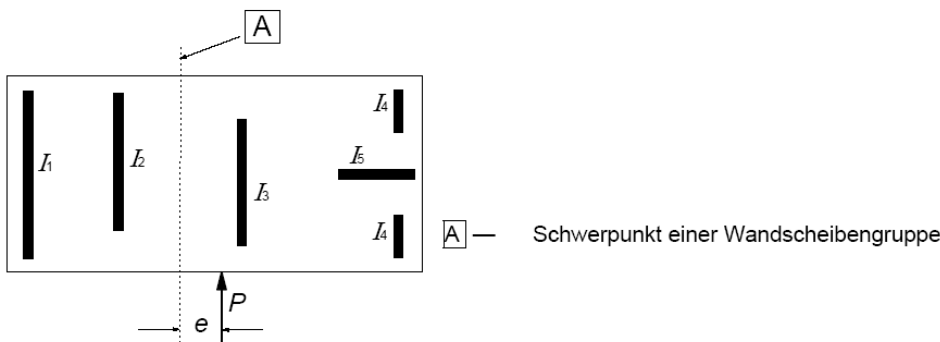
Lastausmitte der Belastung vom Schwerpunkt der Wandscheiben
